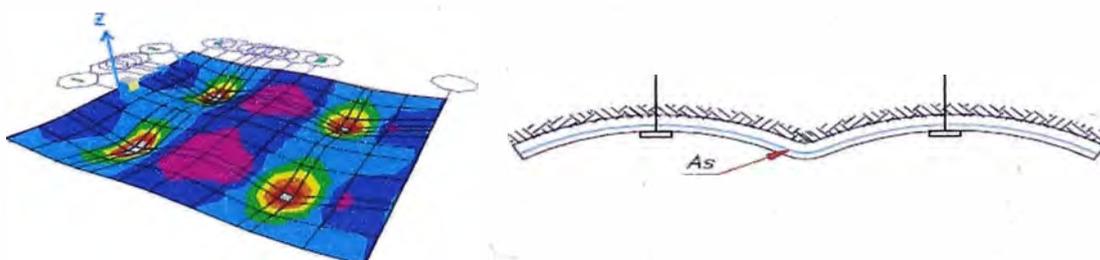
Modelo de una losa de 4 paños de muro anclados.
